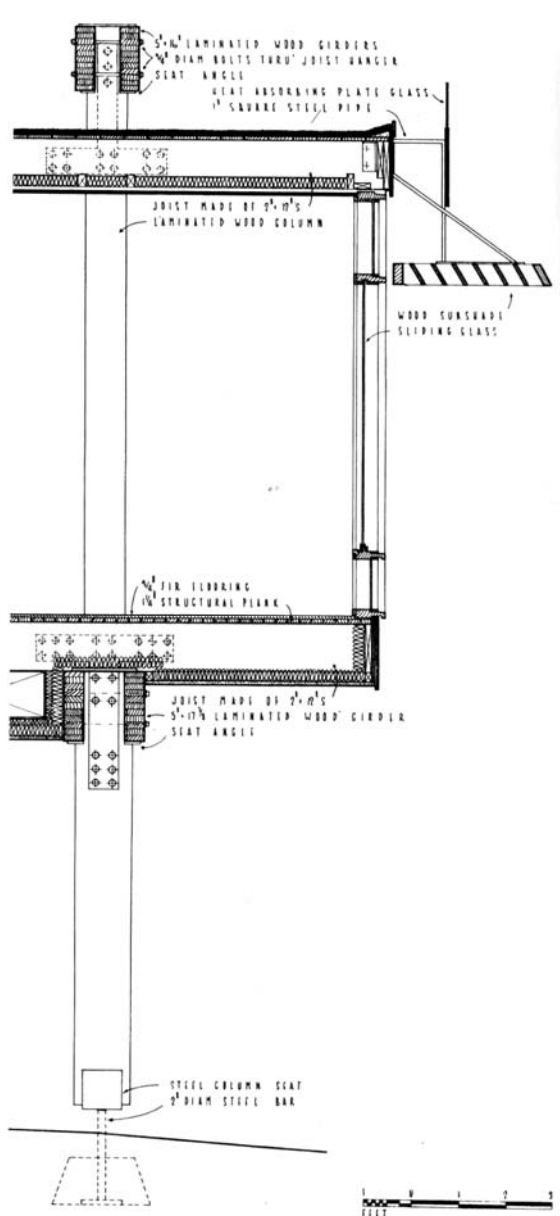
y 178. Corte constructivo por el ala de los dormitorios y detalle del apoyo de los pilares de madera laminada en el suelo.
